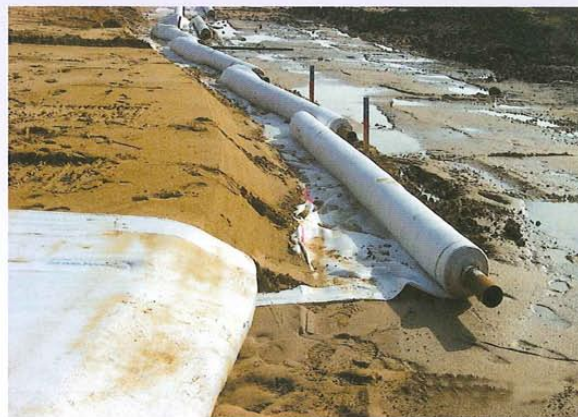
Ein Gewebe aus Polyester als Basisbewehrung beim Bau eines Erdwalls auf weichen Untergrund
